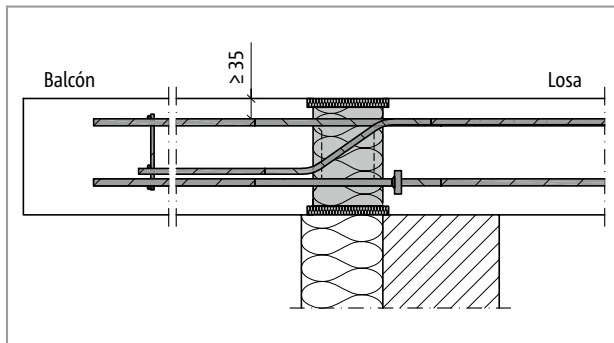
Schöck Isokorb® XT tipo C-CV35: Conexión para sistema de aislamiento térmico exterior (SATE)
